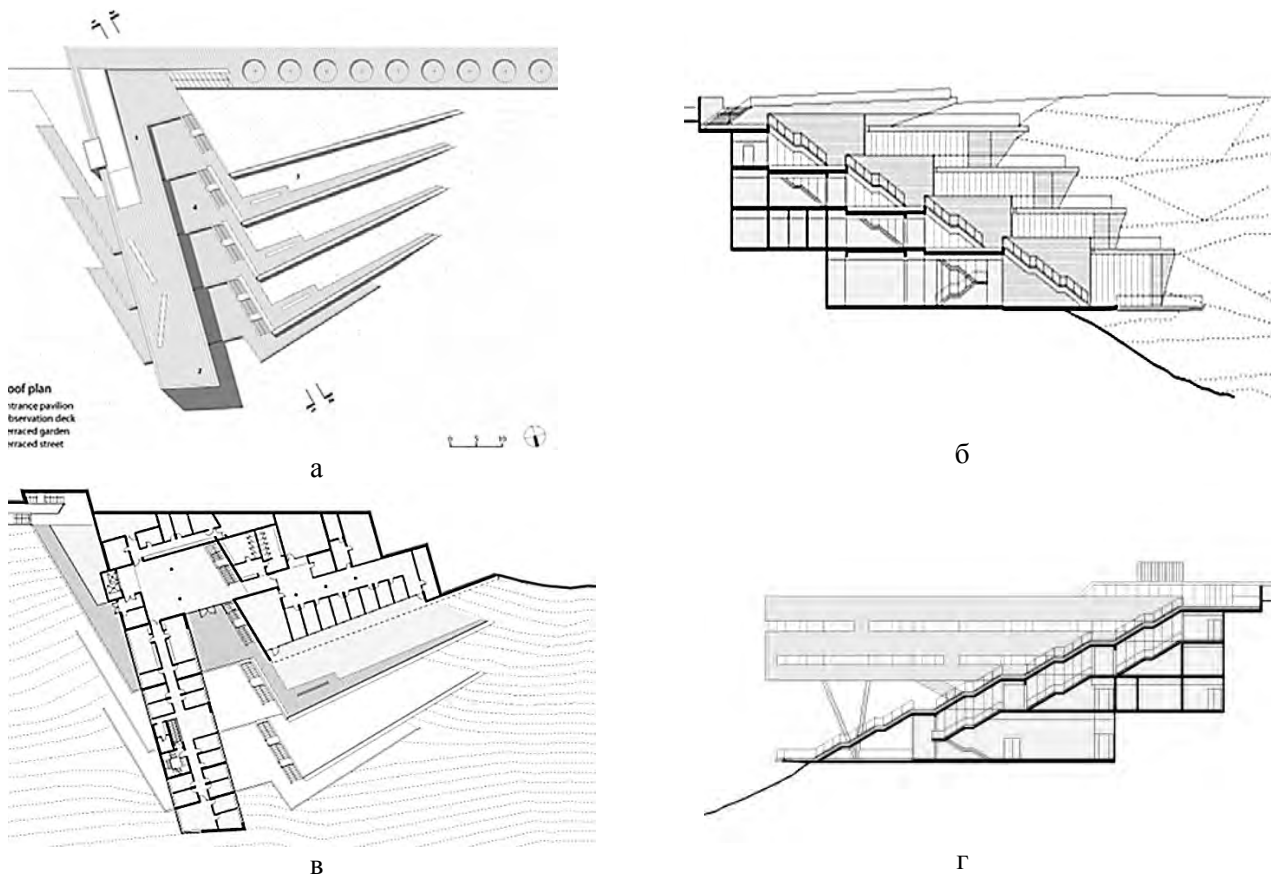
Схема генплану університетського центру Хайфи (а); схема плану поверху (б);
